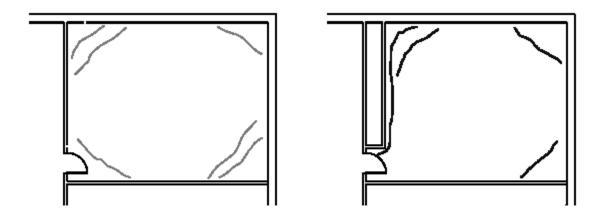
Fisuras de retracción en techos y/o pisos
